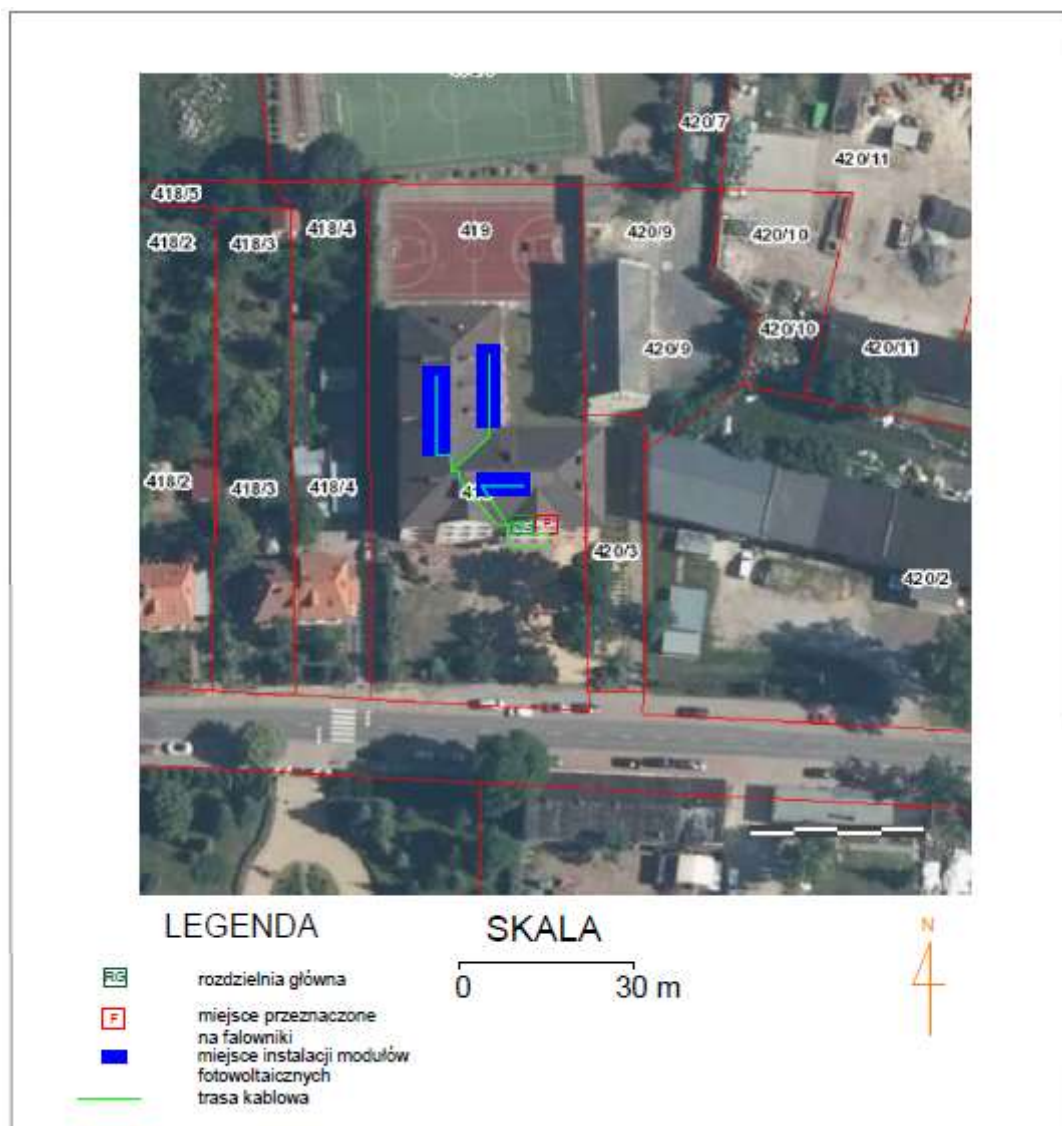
Obszar posadowienia instalacji na zachodniej połaci dachu
